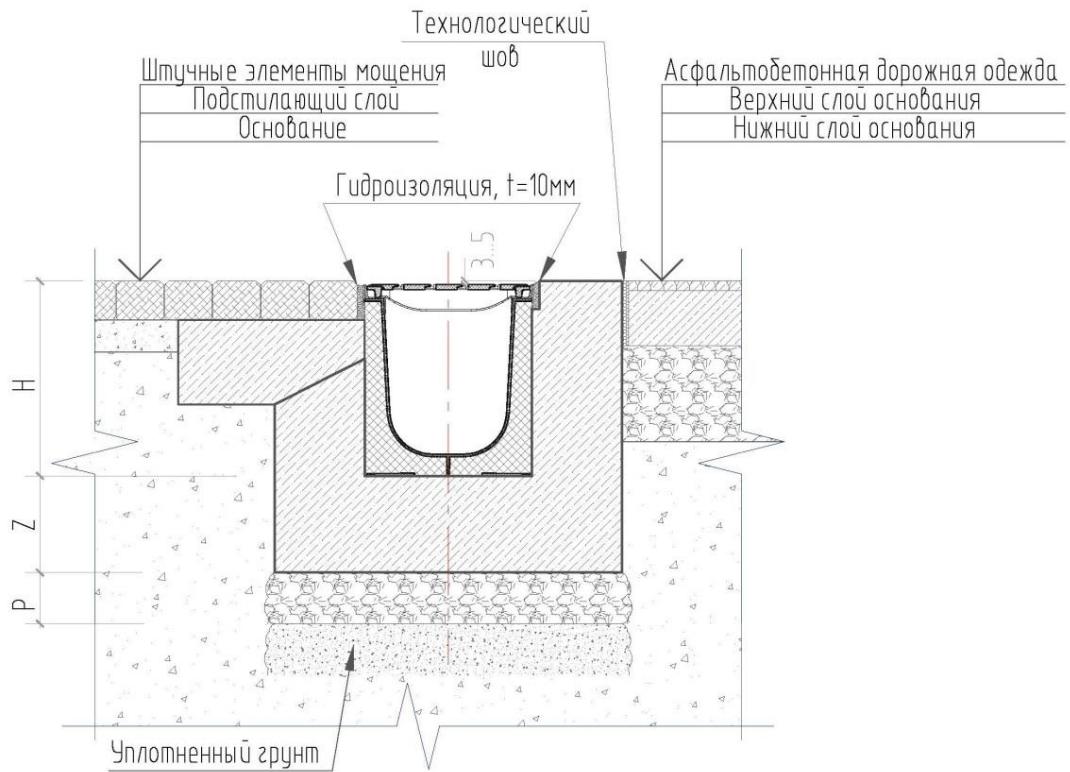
а – Монтаж пластиковых лотков с асфальтобетонным покрытием и штучными элементами мощения.
